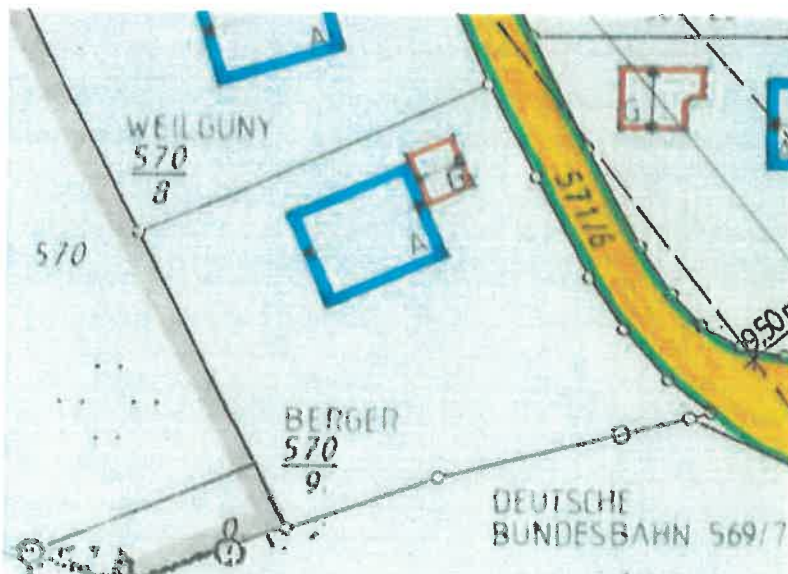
6. Änderung Bebauungsplan „Lauter“, Quelle: Gemeinde Surberg
